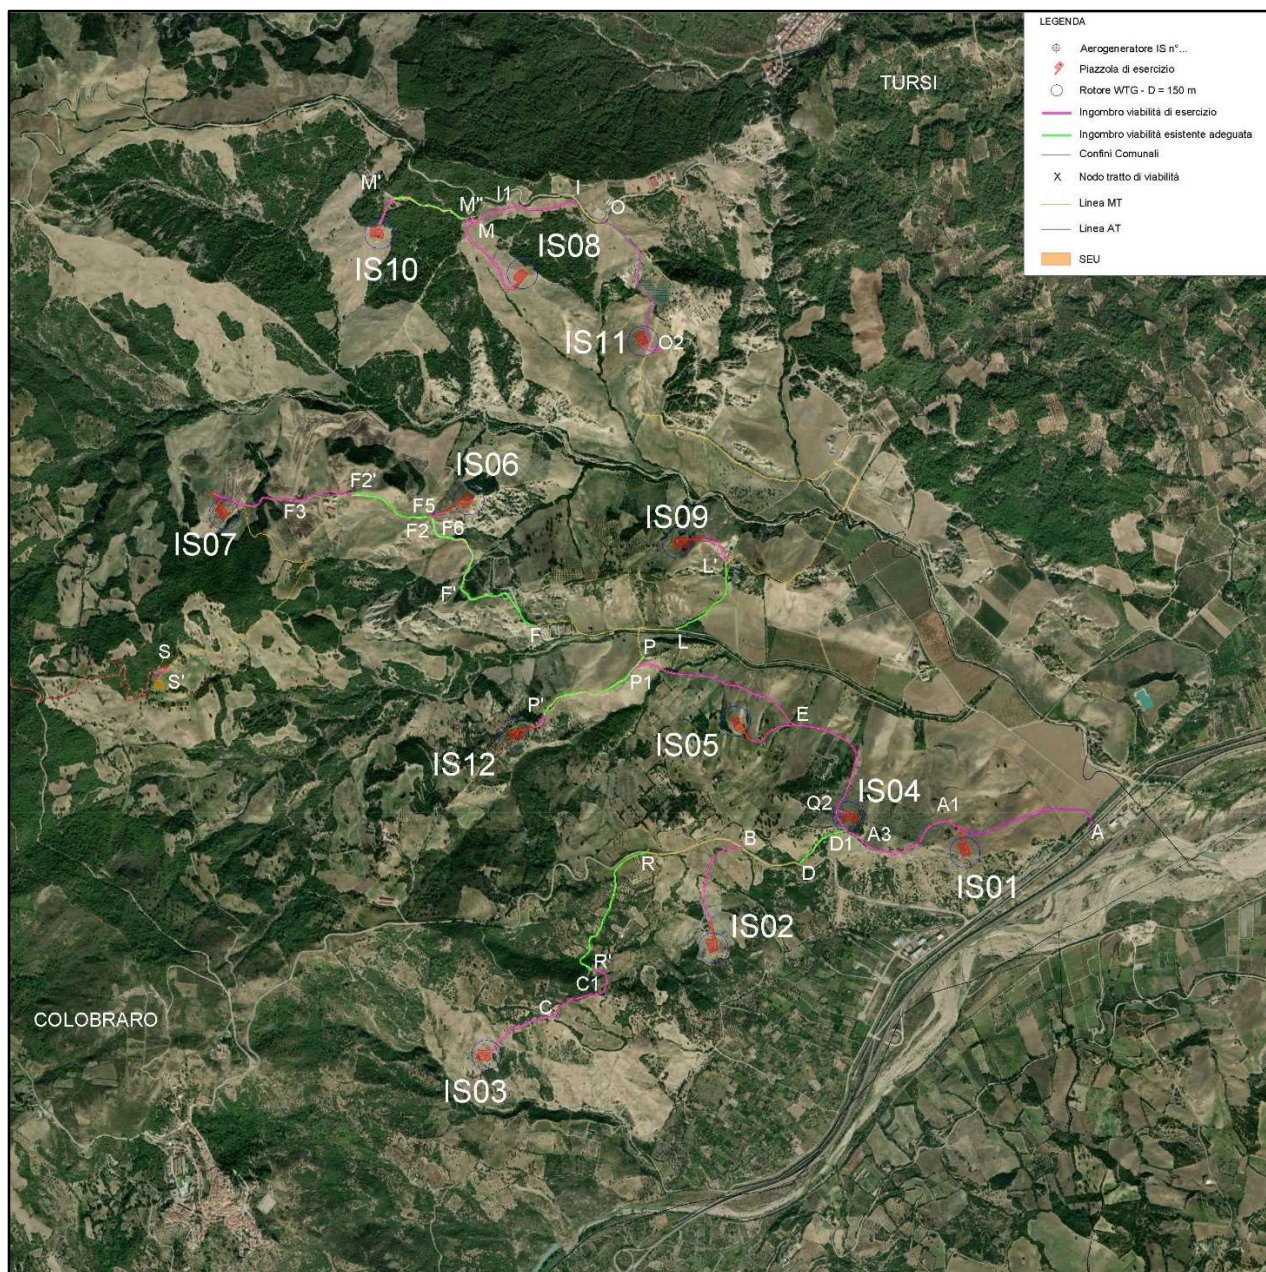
Planimetria viabilità in fase di esercizio
